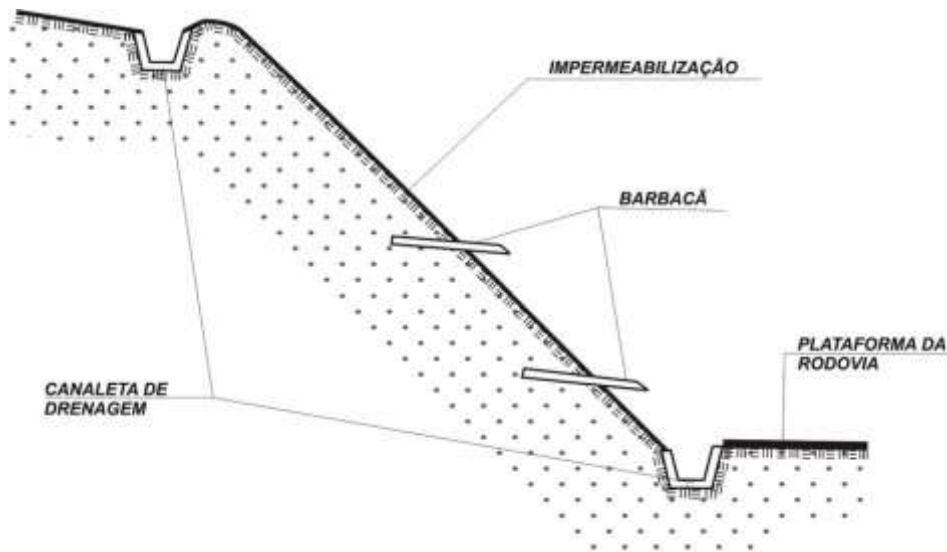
Projeto tipo 18 – Impermeabilização asfáltica.
